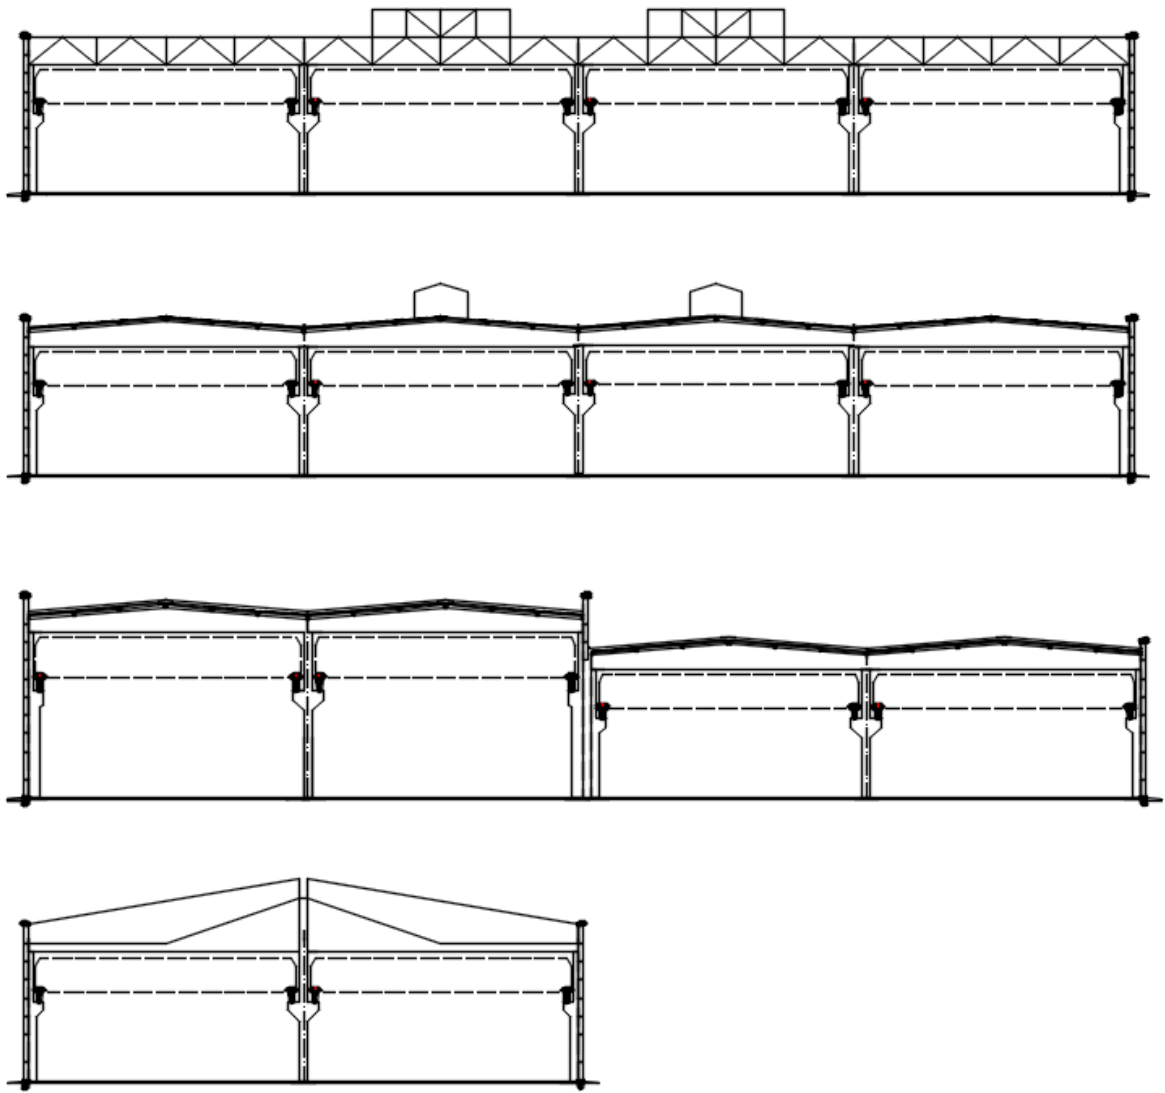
Існуючі типи поперечних рам одноповерхової виробничої будівлі [6]
